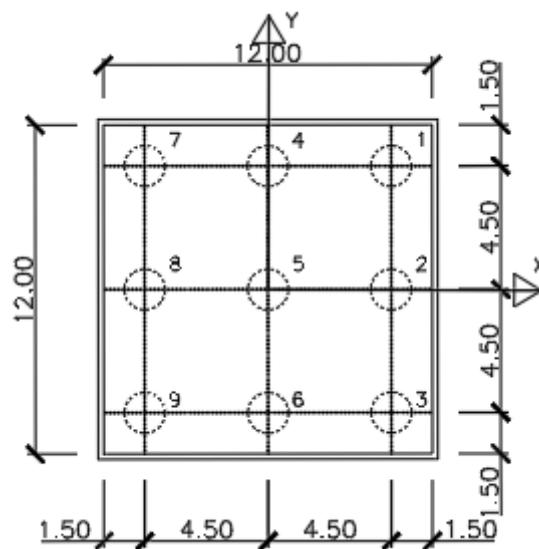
pianta palificata a 9 pali – Pile 3÷11
